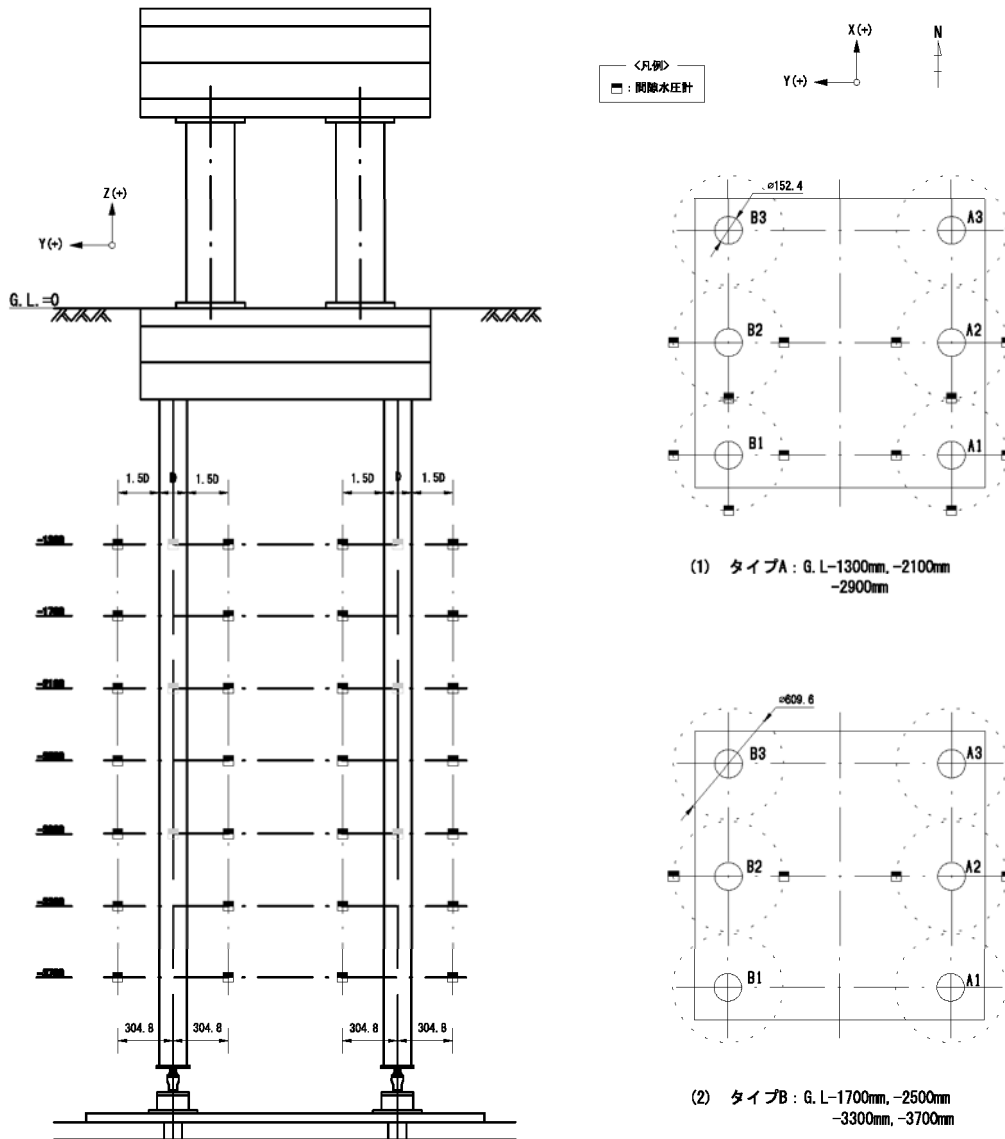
(m) 計測機器の配置：間隙水圧計測アレイ
